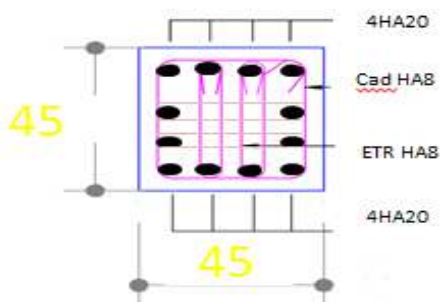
Ferrailage des poteaux de 4^{ème} et 3^{ème} étage
